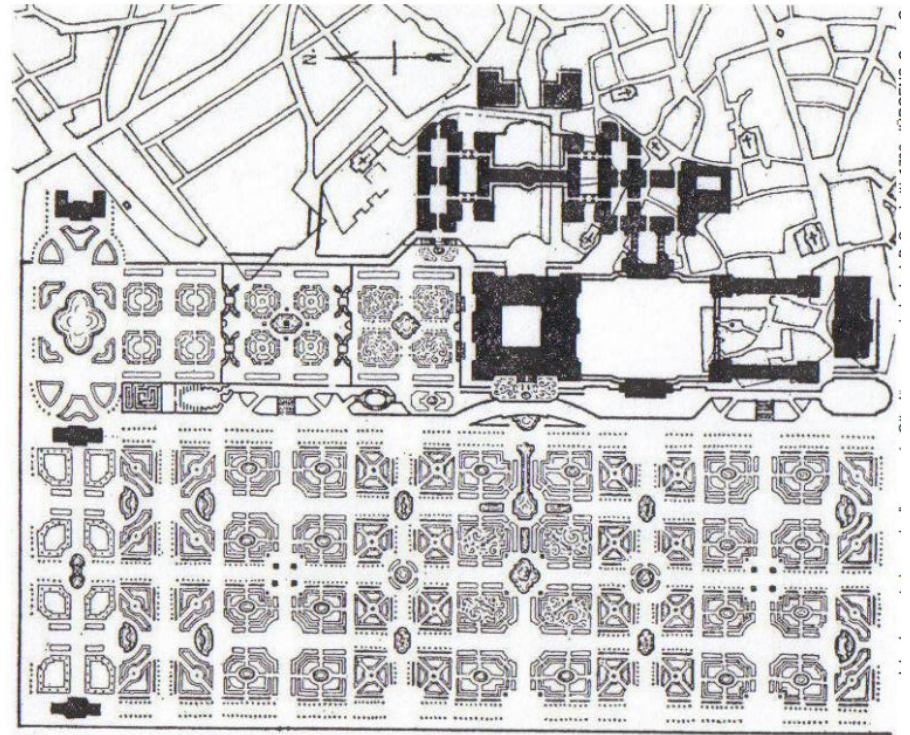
Proyecto de Gian Battista Sacchetti. (Plano copiado de Otto Jurgens. 1918)
